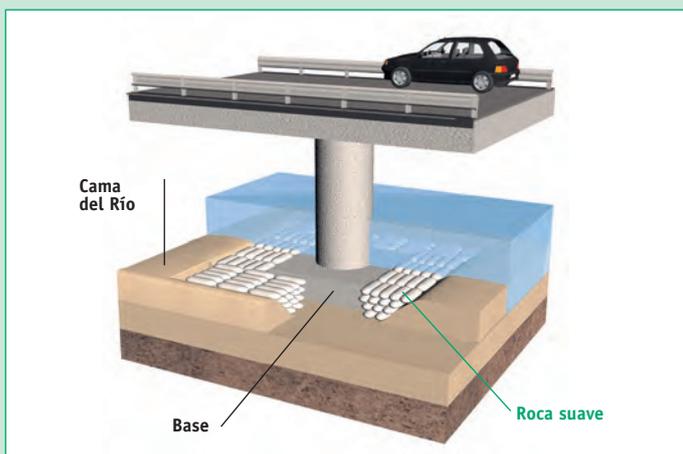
Protección contra socavación para estructuras masivas con Roca Suave.
